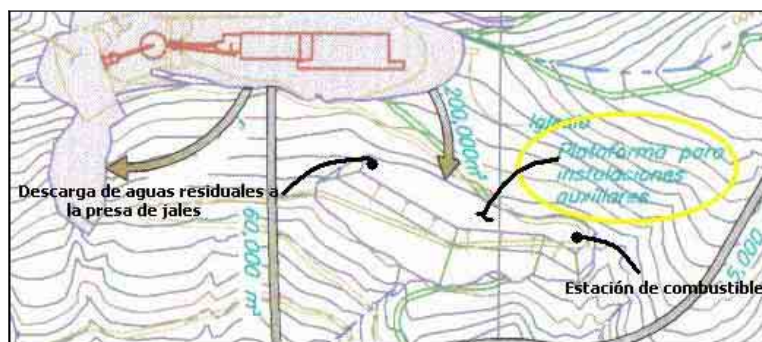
Detalle de la plataforma de instalaciones auxiliares.
